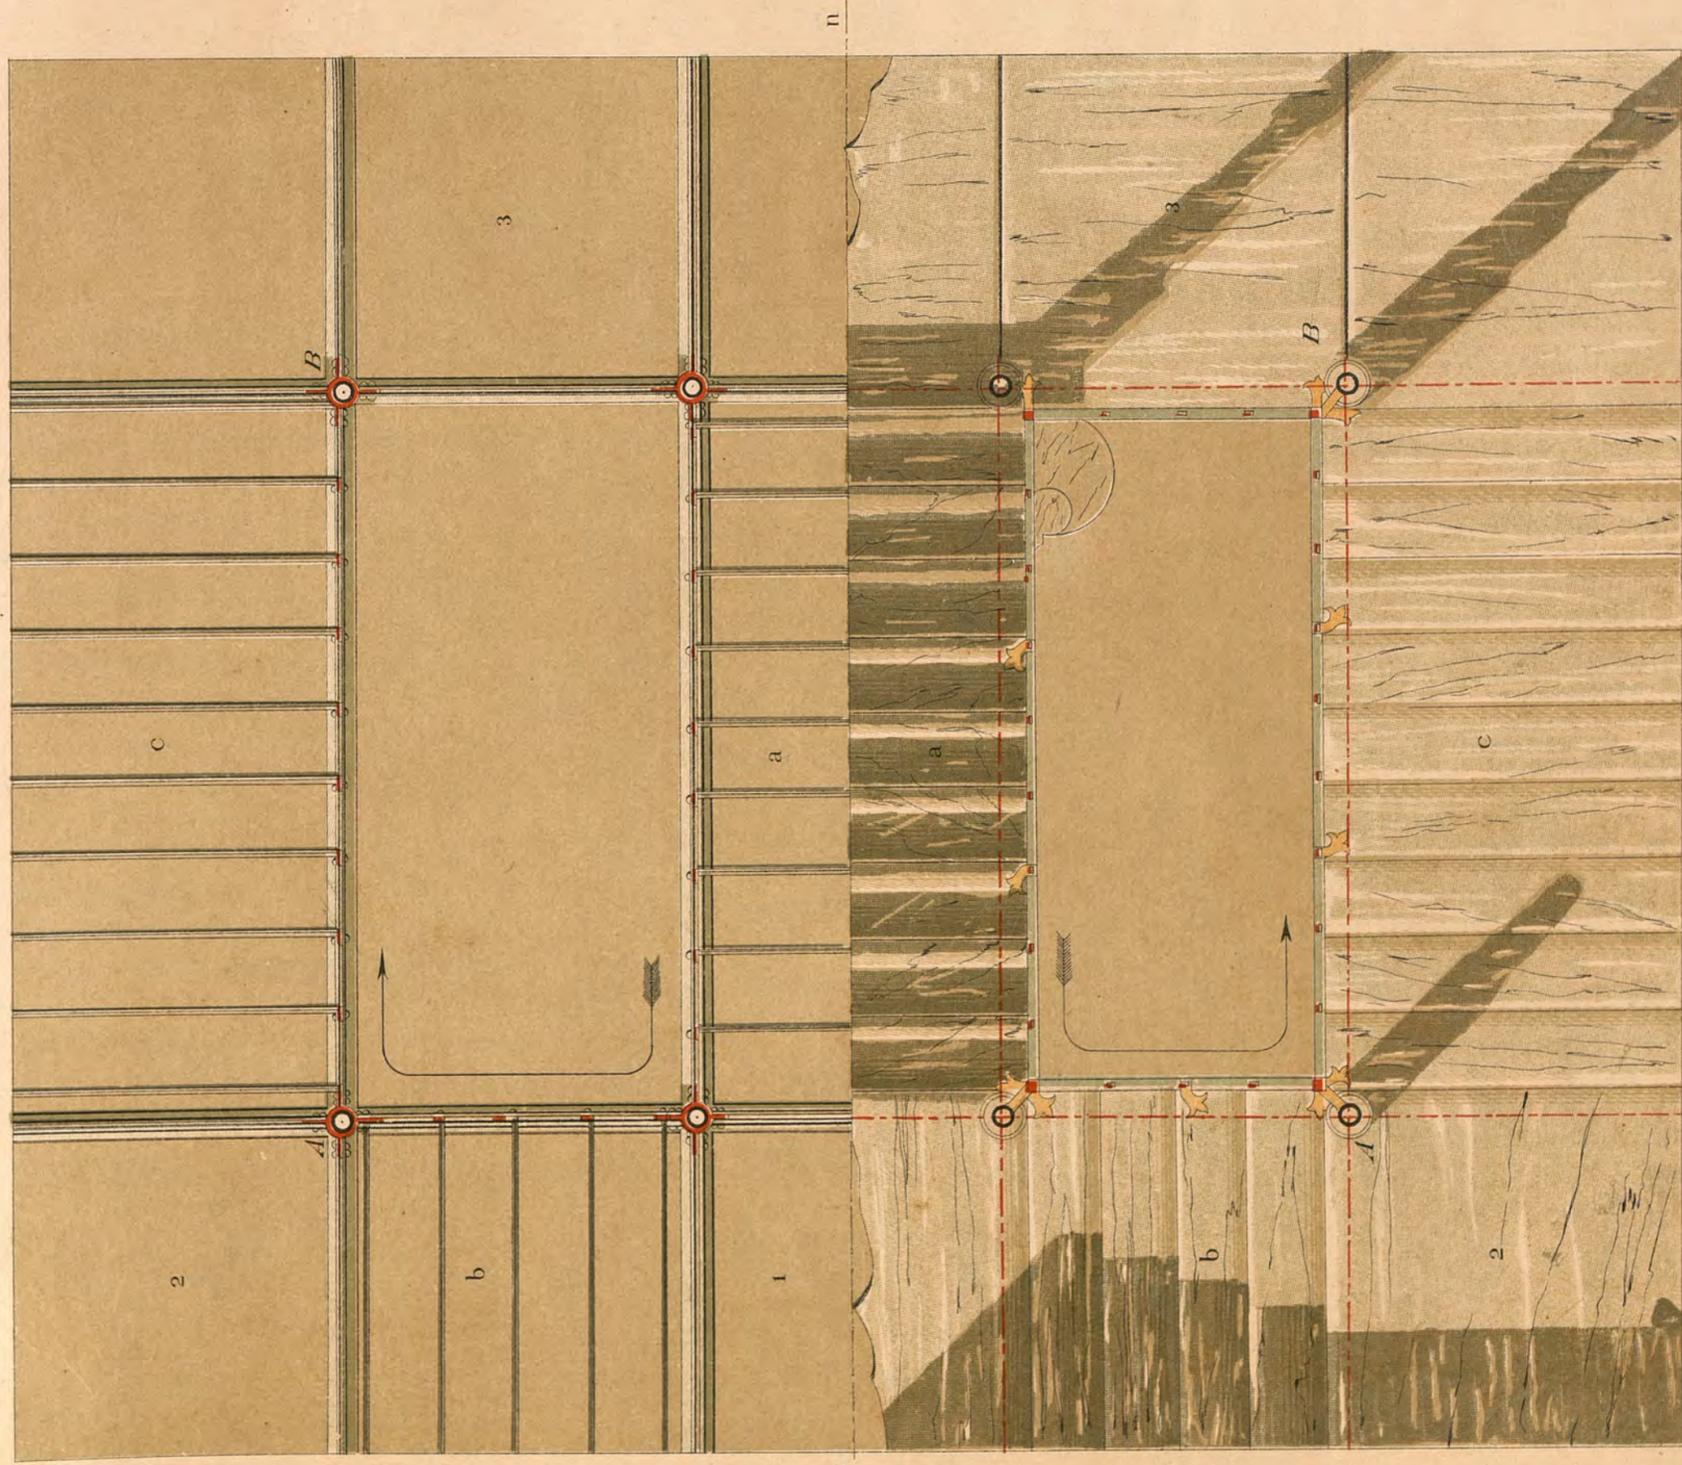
La pianta per l'attacco del pavimento al termine delle branche.
